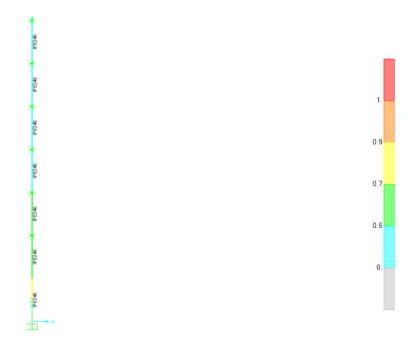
Dimensionamiento del perfil en los grupo R.Pilar y Pilares.
